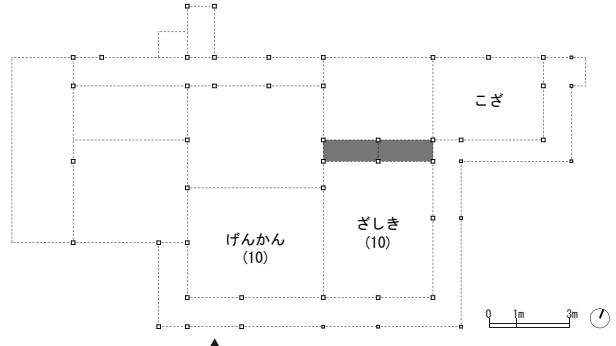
Kk 家住宅復元平面図 (明治 30 年頃)
